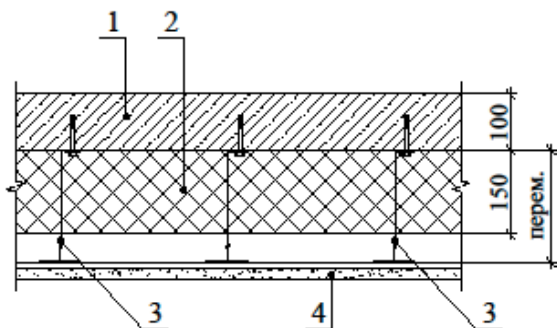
Схема вентилируемого фасада с облицовкой из натурального камня: 1 – железобетонное основание; 2 – утеплитель ROCKWOOL ВЕНТИ БАТТС; 3 – алюминиевая подсистема навесного фасада MA Vent KN400; 4 – облицовка плитками из натурального камня толщиной 20 мм
